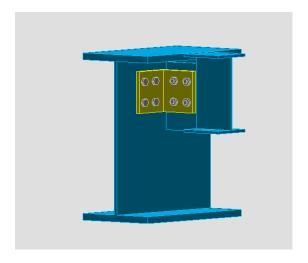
assemblage poutre solive IPE300-HEA550
